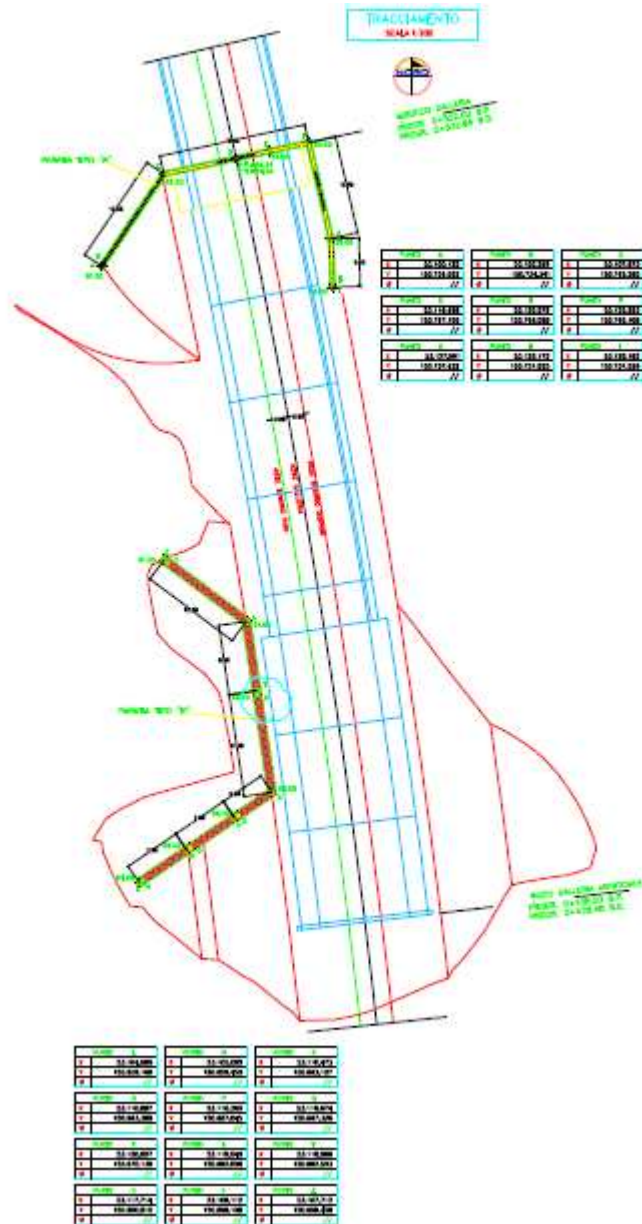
Vista dall'alto della galleria e delle due paratie a protezione.
